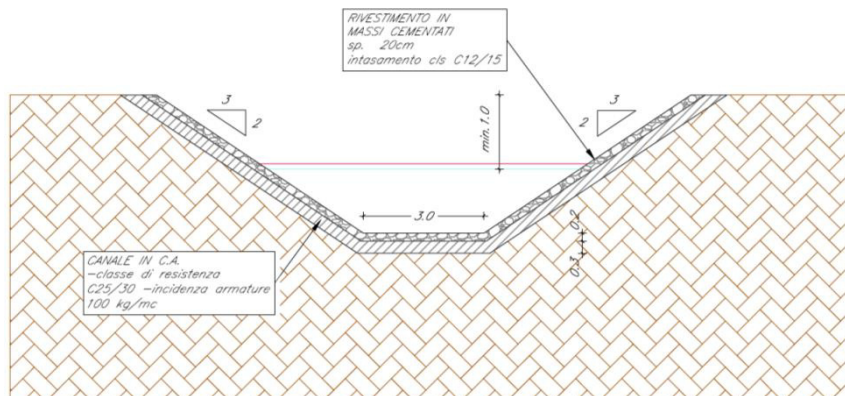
Sezione tipo sistemazione corso d'acqua 9+600.
